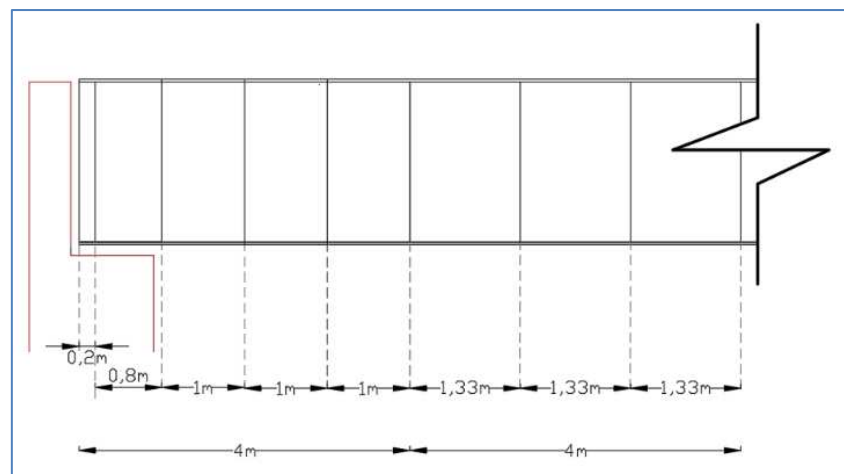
Vista en perfil de la ubicación del rigidizador transversal intermedio.
